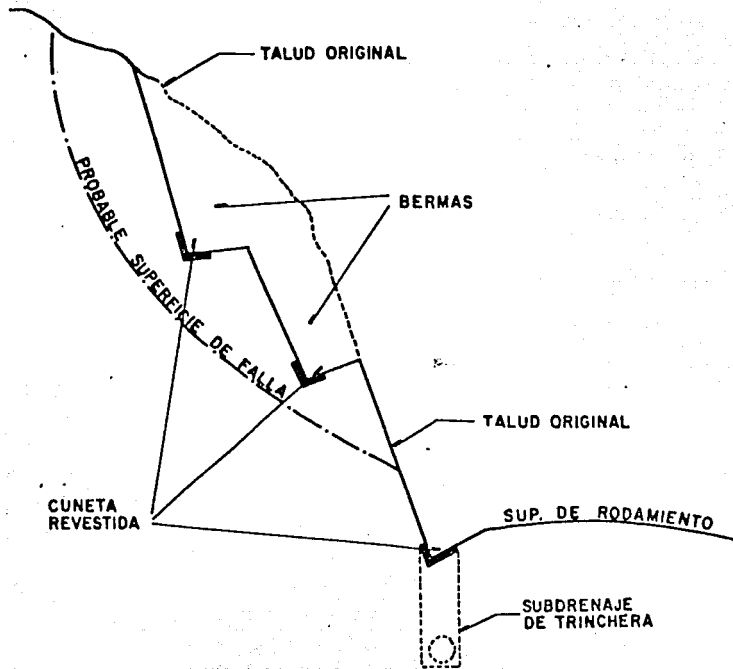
Construcción de bermas en cortes para evitar la falla del talud.
